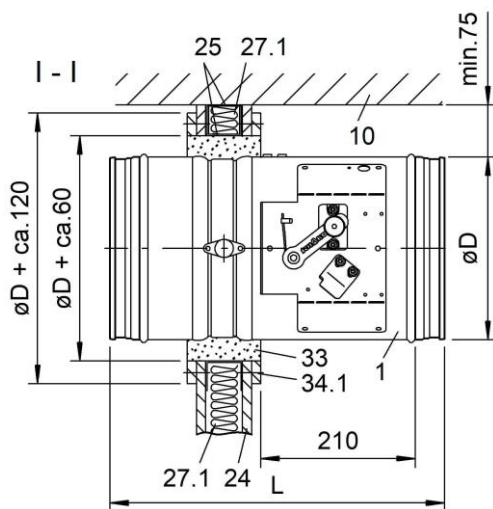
montaggio a umido in pareti divisorie leggere (F30) direttamente sotto soffitti massicci (BSK-RPR 100 bis ≤ 250)
